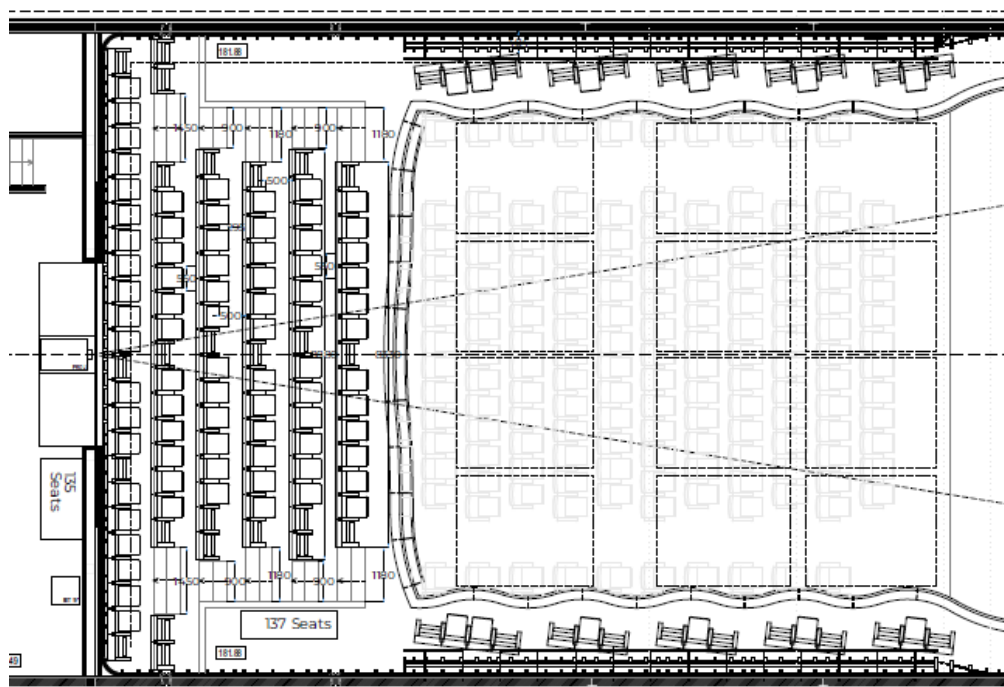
Planta do Piso 1 (balcão) do Teatro Jordão. [36]
